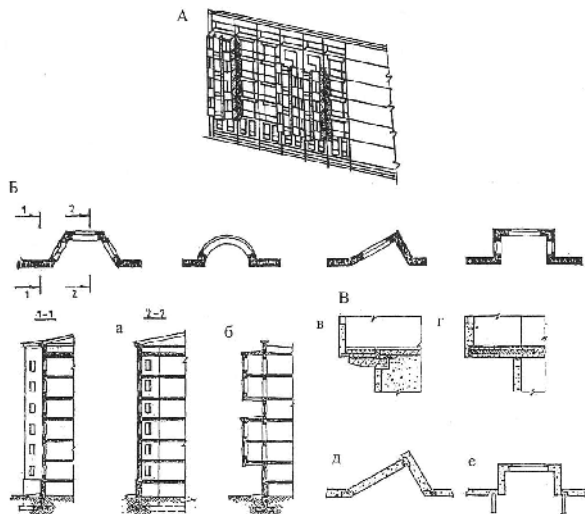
Эркеры: А — элемент фасадной плоскости с эркерами; Б — формы эркероз; В — схемы конструктивных решений; а — несущего эркера; б — висящего, в — опирания эркера на консольные балки; г — на консоль панели перекрытия с утепляющей прослойкой; д — эркер из стеновых панелей; е — то же, из объемного элемента
